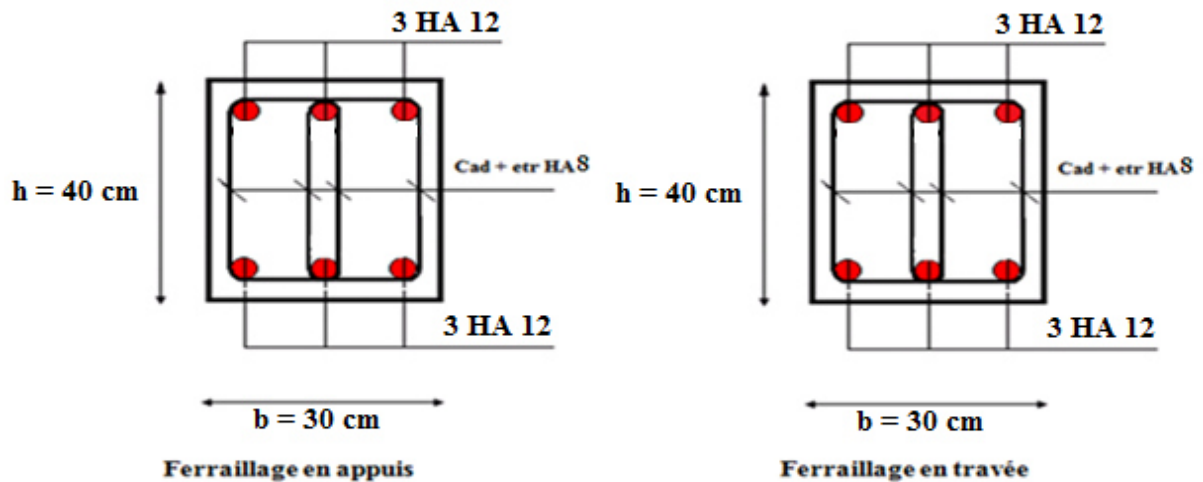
Schéma du ferrailage de la poutre palier.
